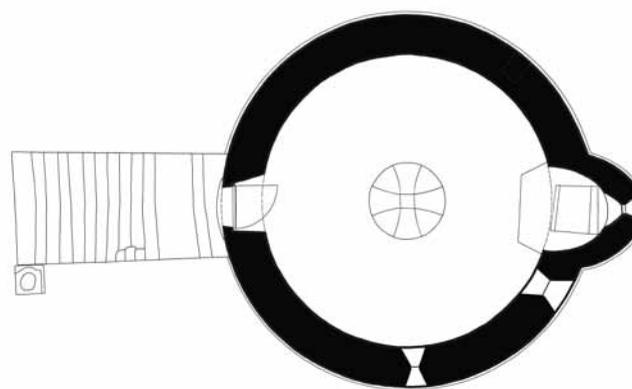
Grundriss St. Marein, M 1:200. TU Graz/Pittino 1981.
